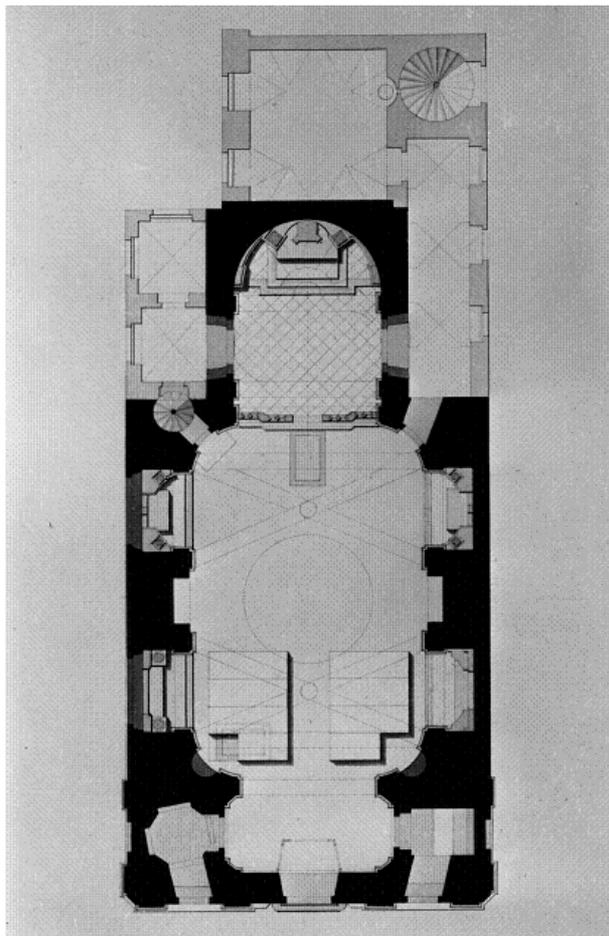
Krets, Pfarrkirche Krets, Grundriss
